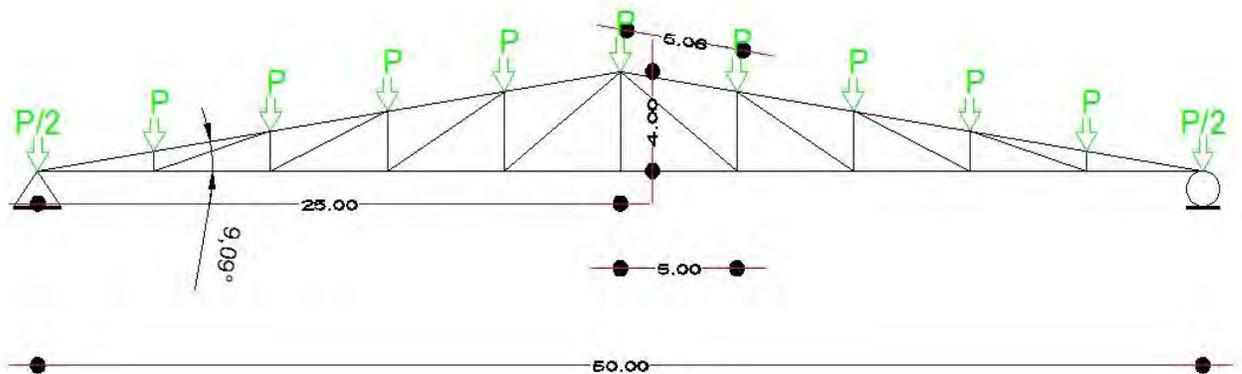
Propuesta de armadura para claro de 50 m y 2 apoyos.
